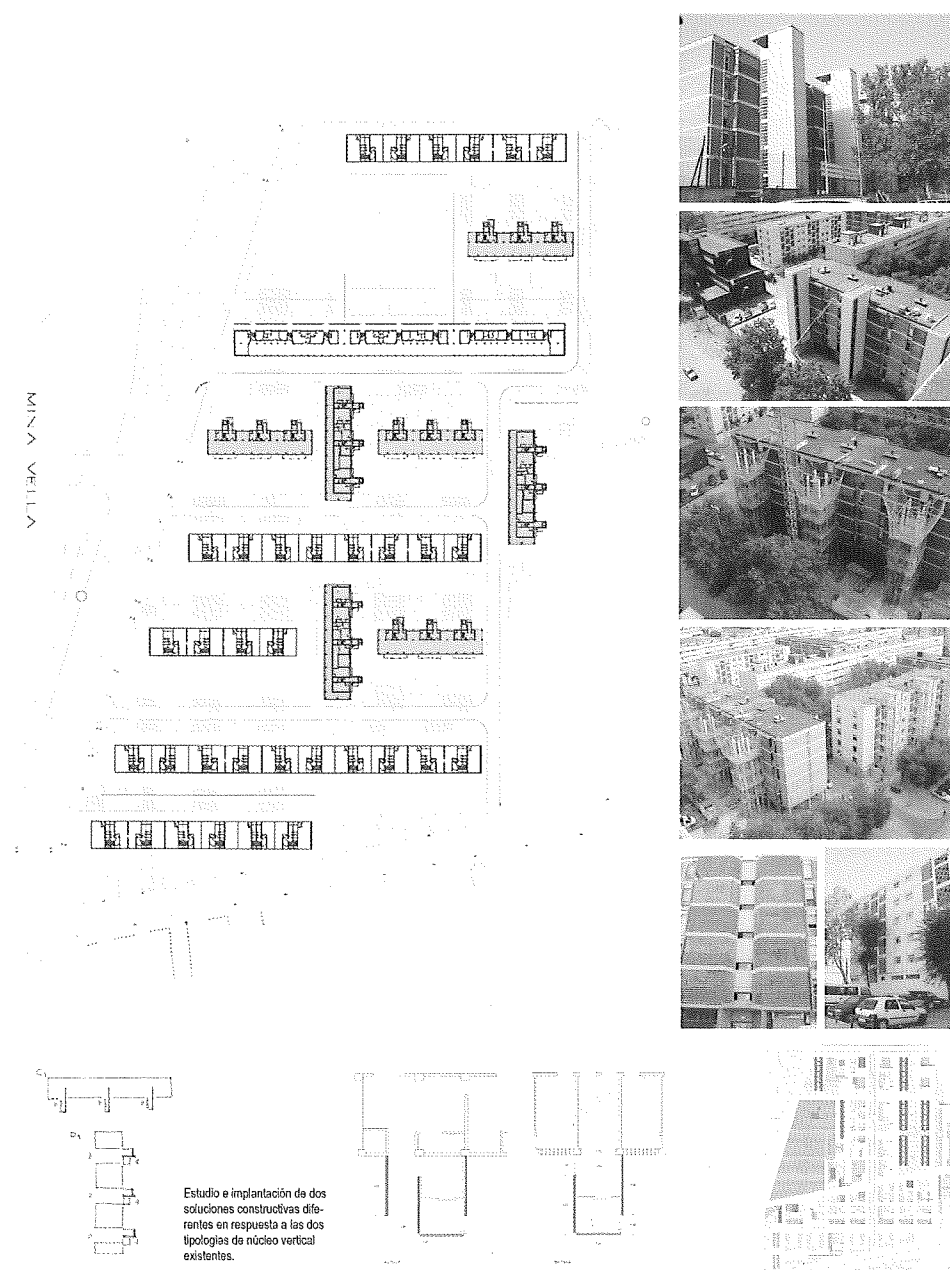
Nuevos ascensores en Mina Vella. Planimetría, detalle de plantas baja y pisos y fotografías de las obras.
